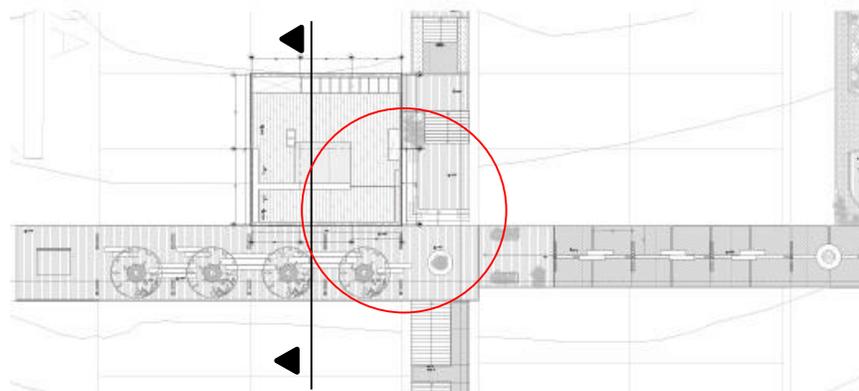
Planta de cubiertas esquina del proyecto. Fuente: Autor.
